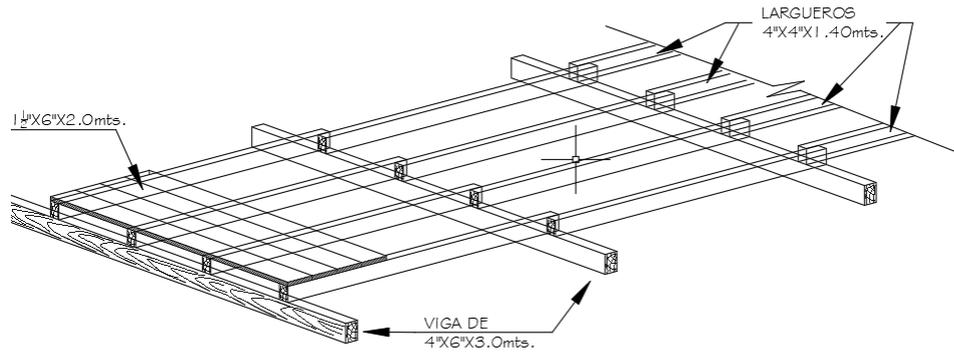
Detalle de Suspensión (Fuente: Propio)
